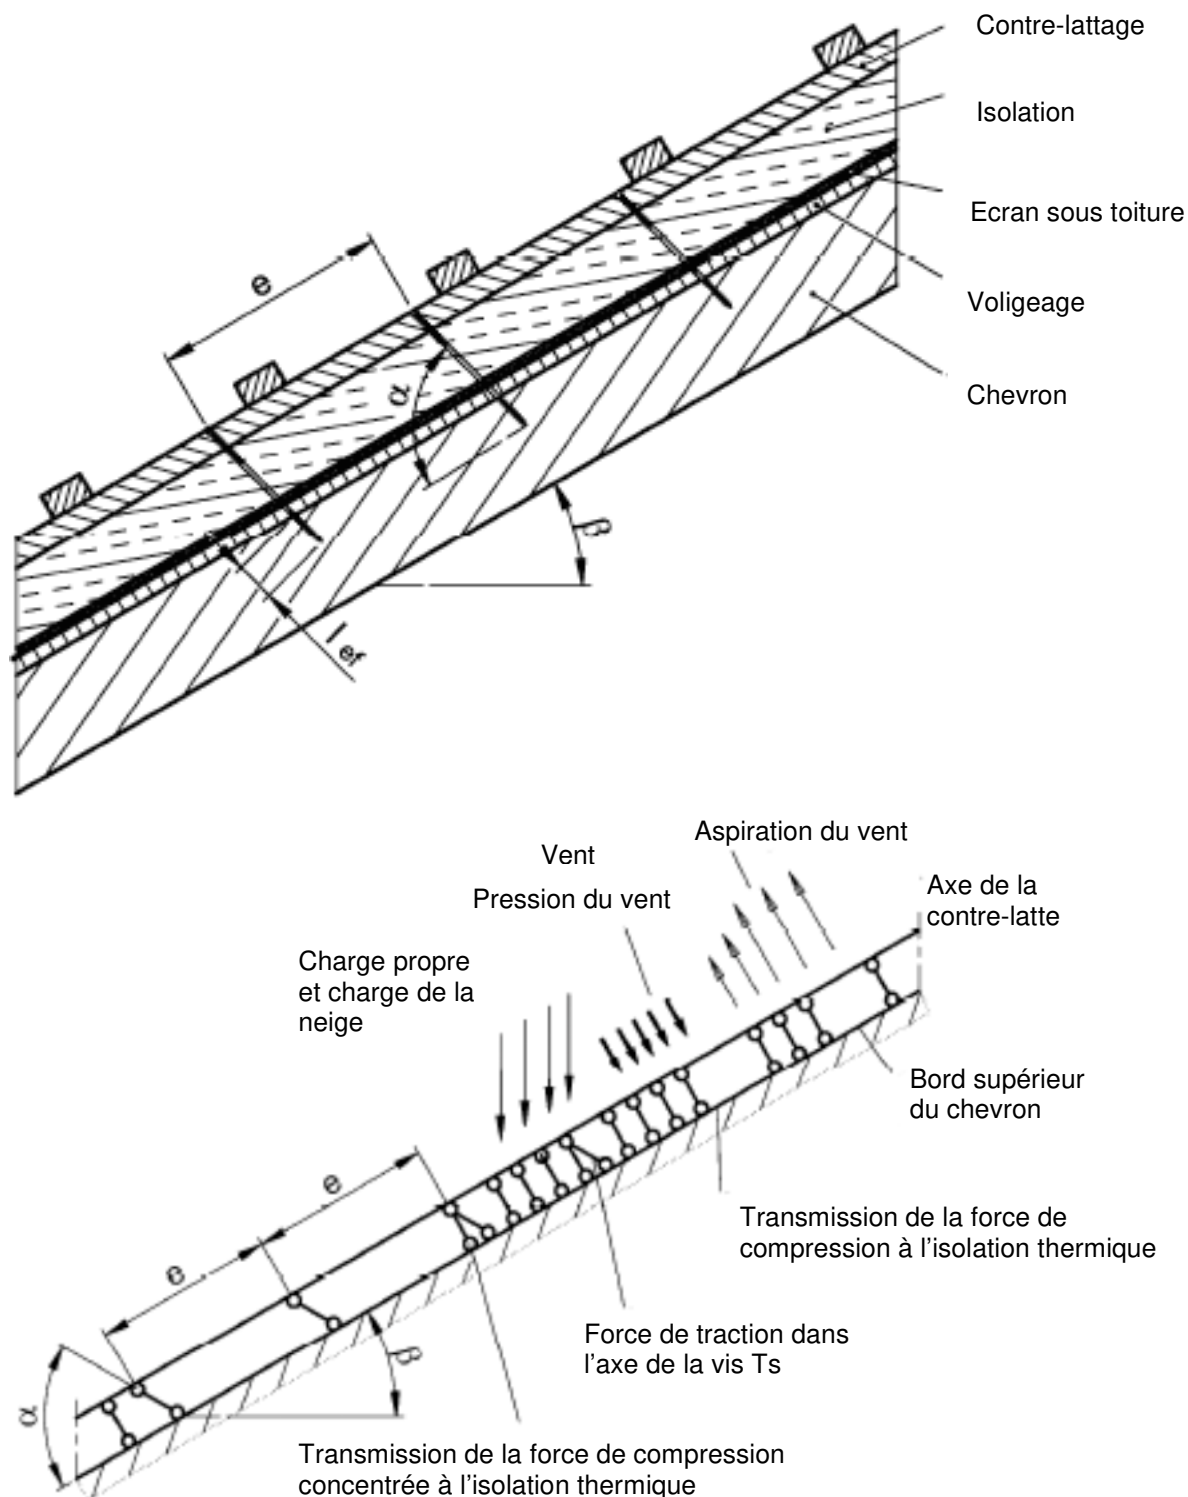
Fixation de systèmes d'isolation sur toiture sur chevron – Modèle statique pour des vis disposées parallèlement
